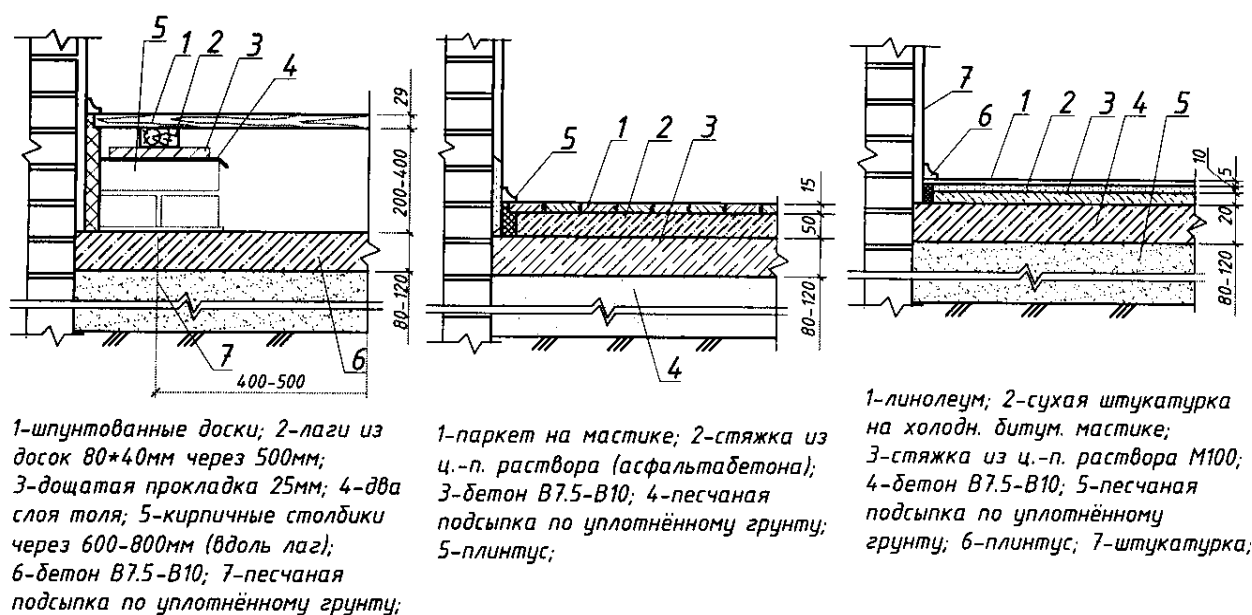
Полы первого этажа зданий без подвалов (гидроизоляция условно не показана)
